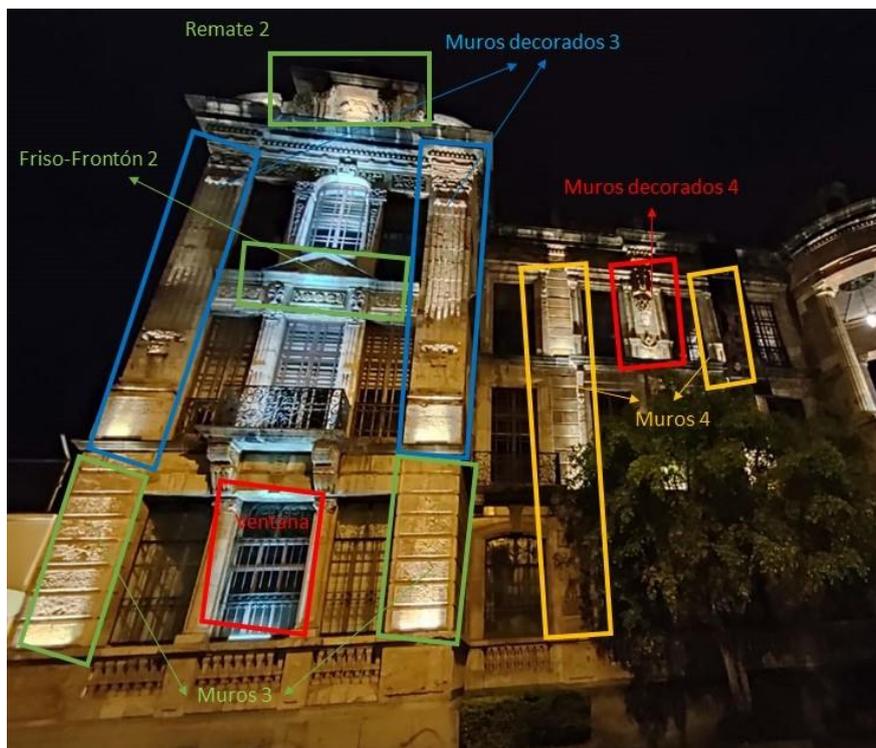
Secciones de la fachada lateral Borrero Alcaldía. [Autores]
